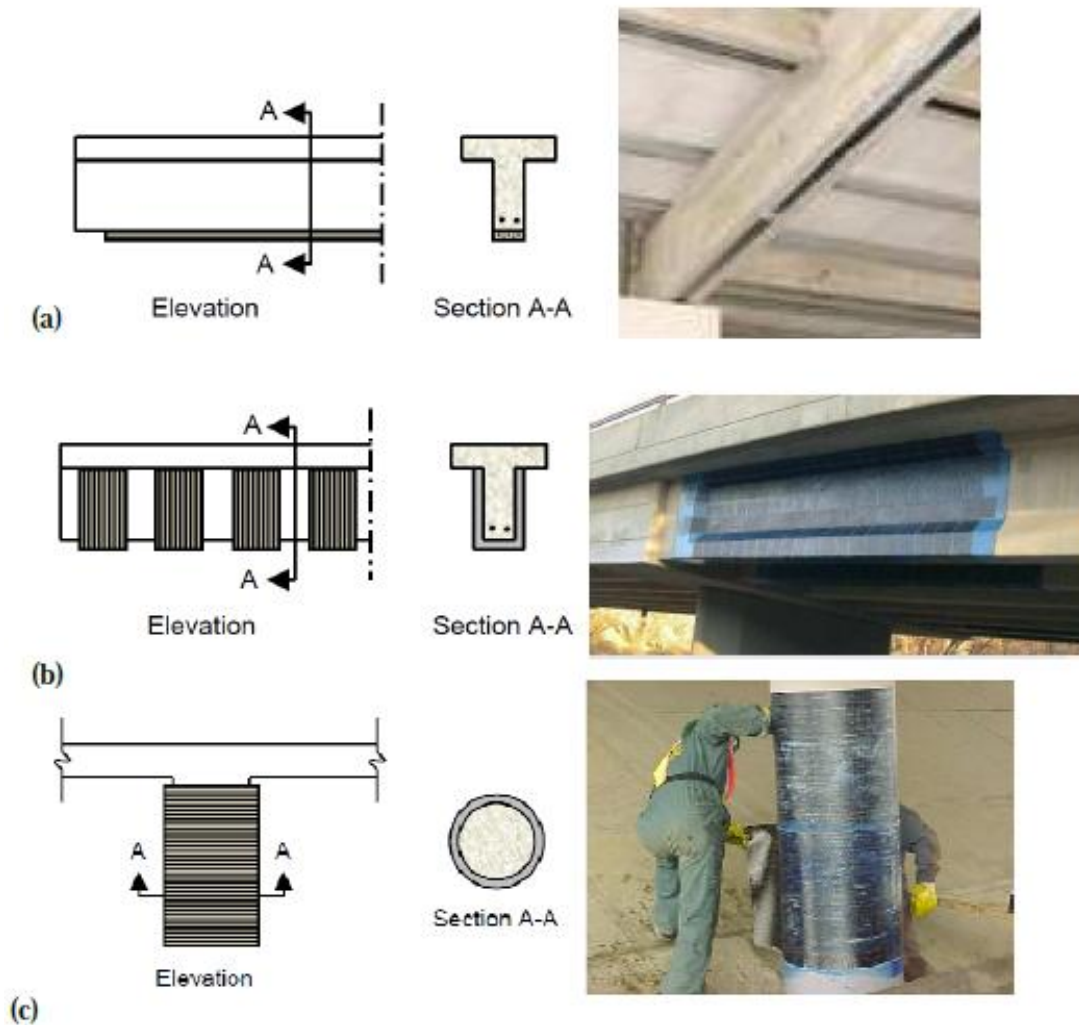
principales applications de renforcement par composites collés sur ouvrages [36]
